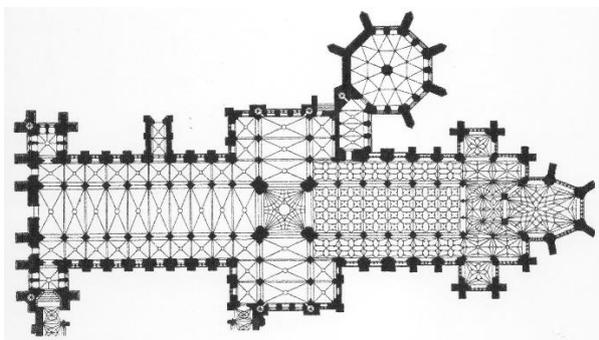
und 8 Wells, Kathedrale, Grundriss und Gesamtansicht
